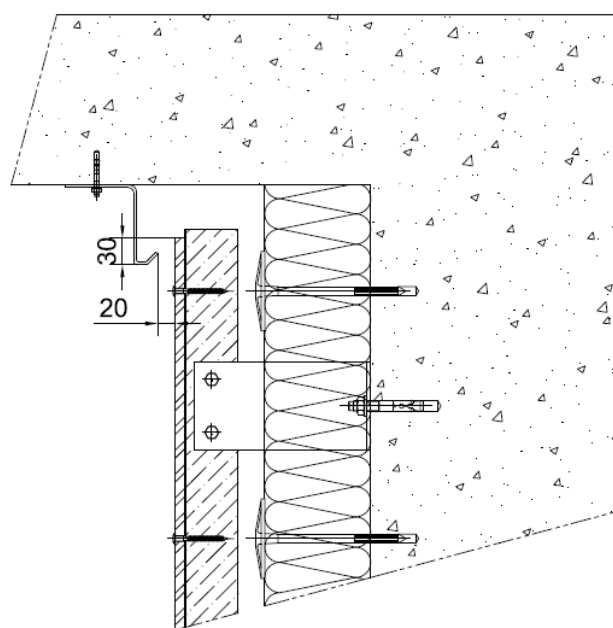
Sección vertical. Detalle de coronación bajo parapeto.
